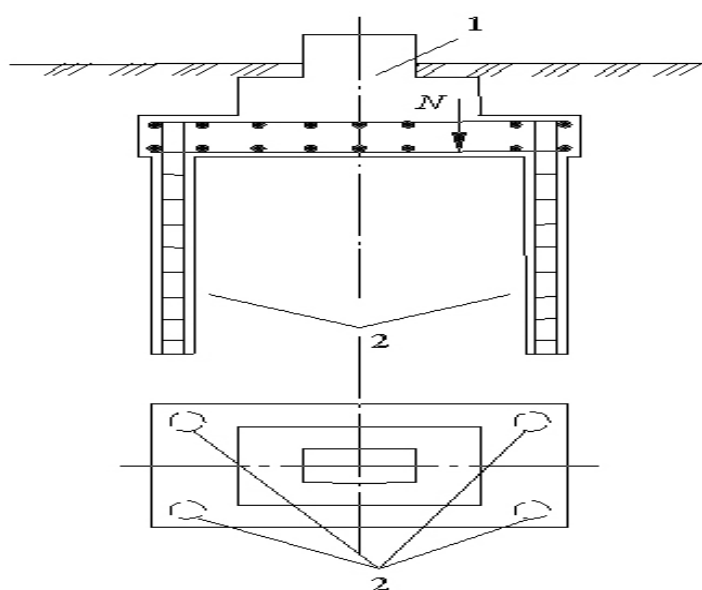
Схема фундамента с анкерами: 1 – фундамент; 2 – анкера
